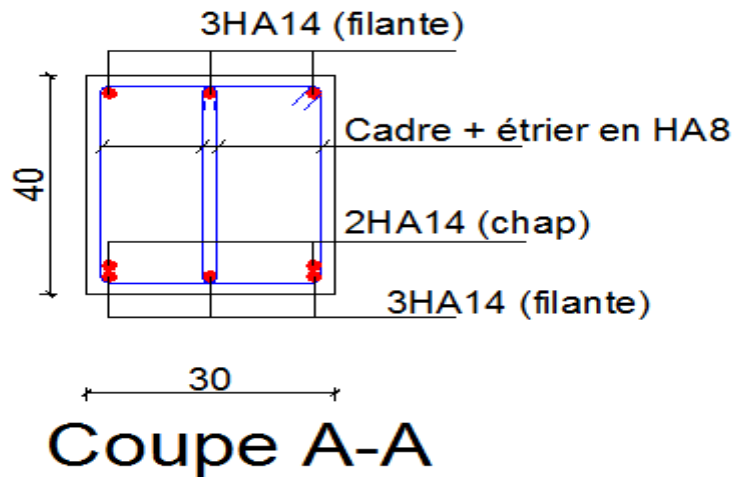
3 : Ferrailage en travée d'une poutre principale.
